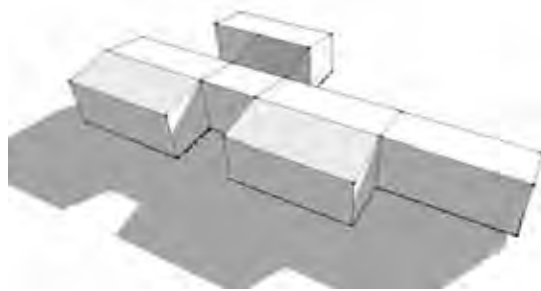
Vivienda Aislada Fuente: Elaboración propia 2010
